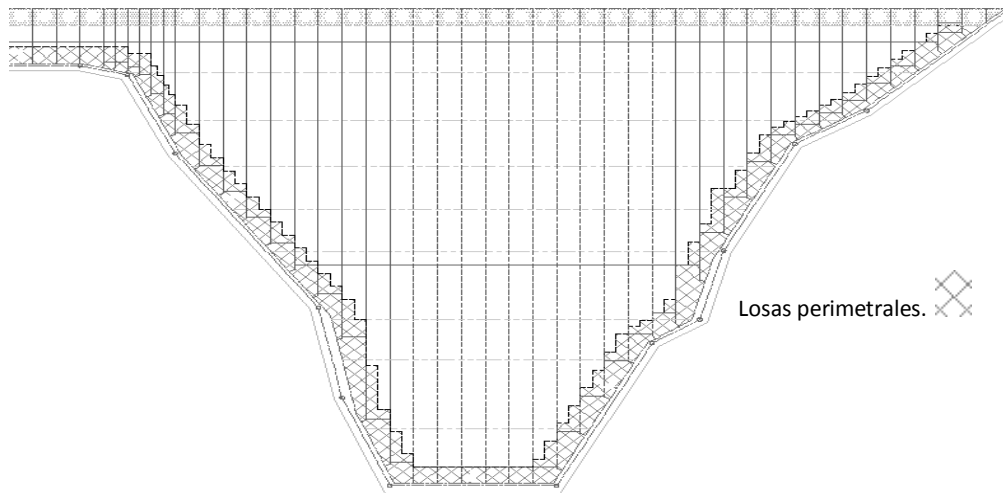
Esquema de las losas que forman la cara de concreto, se aprecia la zona de las losas perimetrales. Cortesía C.F.E.
